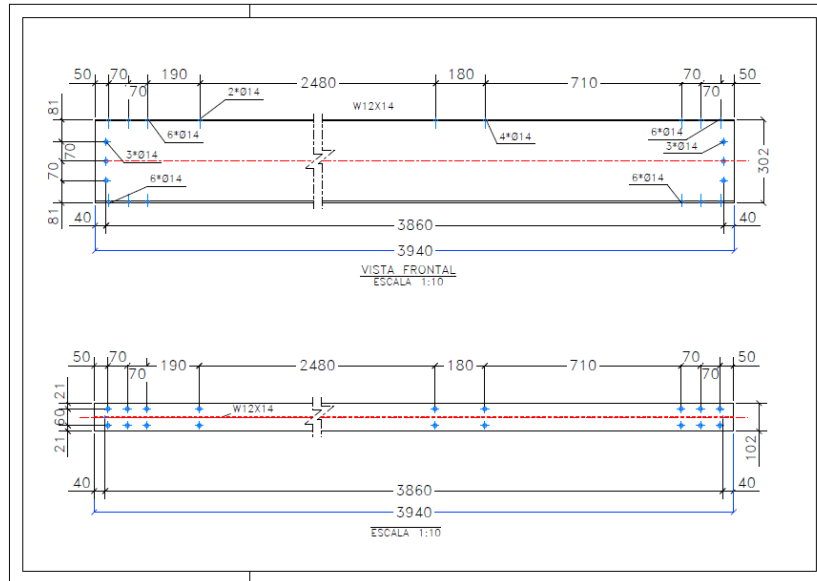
Plano de parte. Fuente: PERALTA INGENIERÍA S.A.S.
